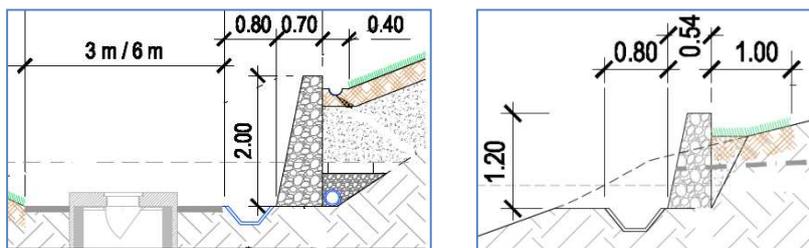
Presso le aree di lavorazione dei pozzi drenanti e dei dreni suborizzontali
